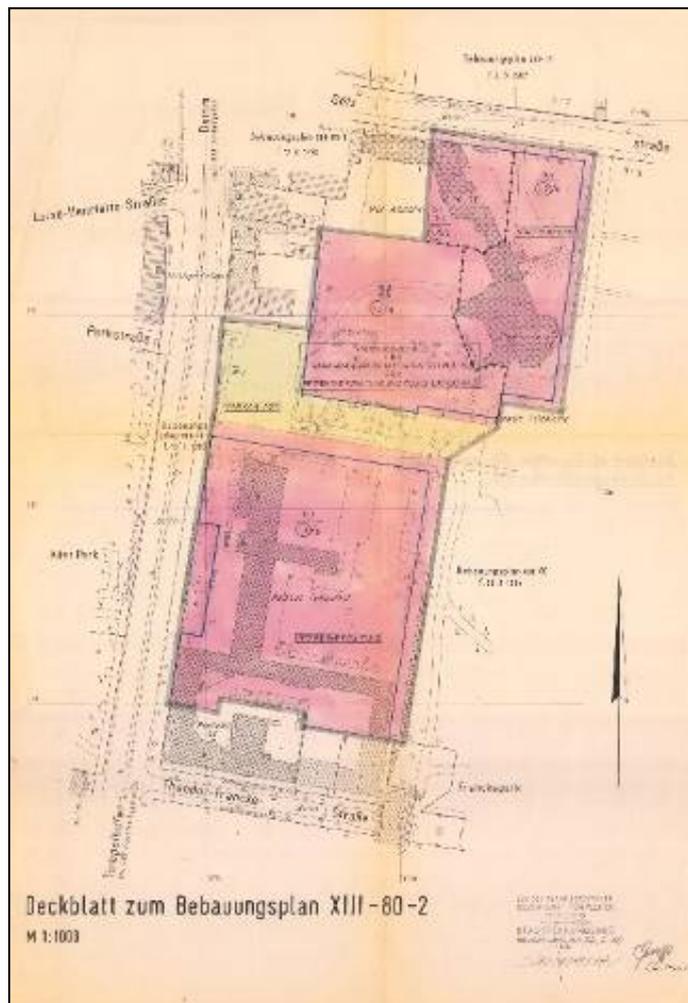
Bebauungsplan XIII-80-2 (Entwurf) (ebda.)
